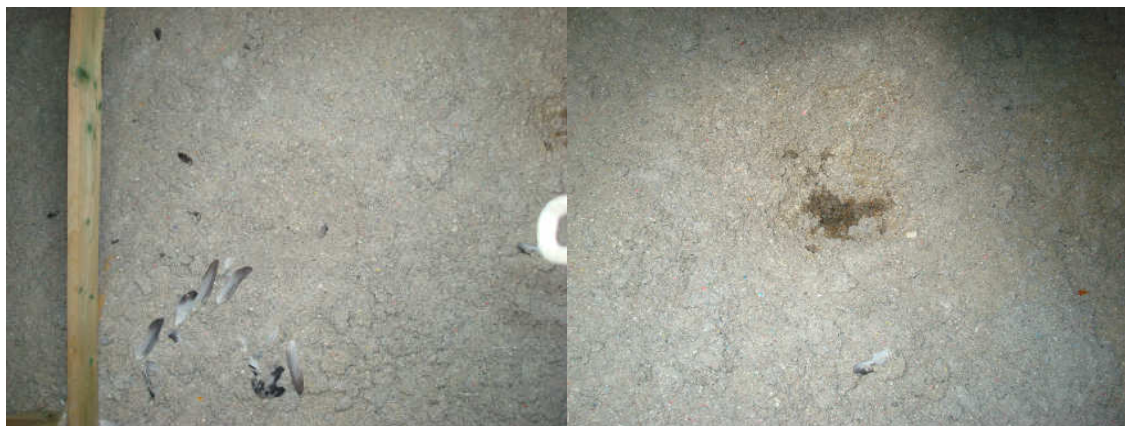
Detail uložení sloupku na dřevěná práh, jenž je zakryt tepelnou izolací
